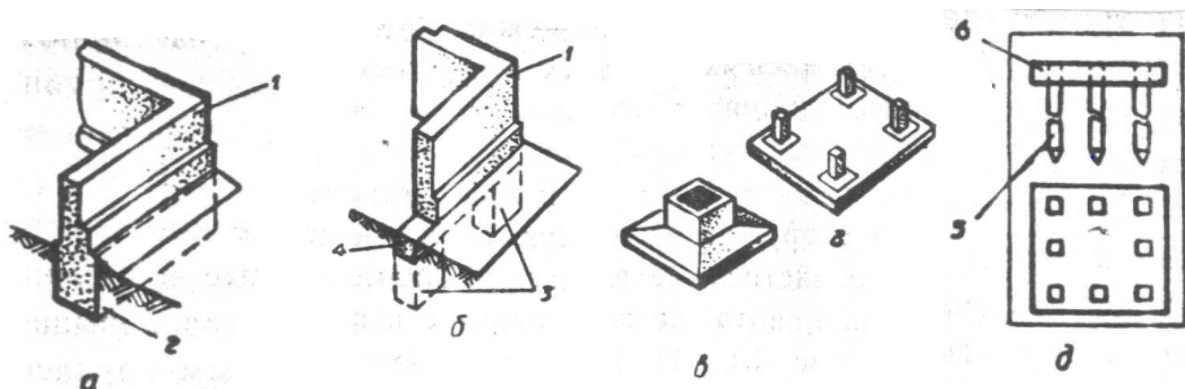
Конструктивные схемы фундаментов: а - фундамент; б – столбчатый под стены; в – фундамент стаканного типа; г – сплошная монолитная плита; д – свайные фундаменты; 1 – стена; 2 – ленточный фундамент; 3 – столбчатый фундамент; 4 – фундаментная балка; 5 - свая; 6 – монолитный ростверк.
